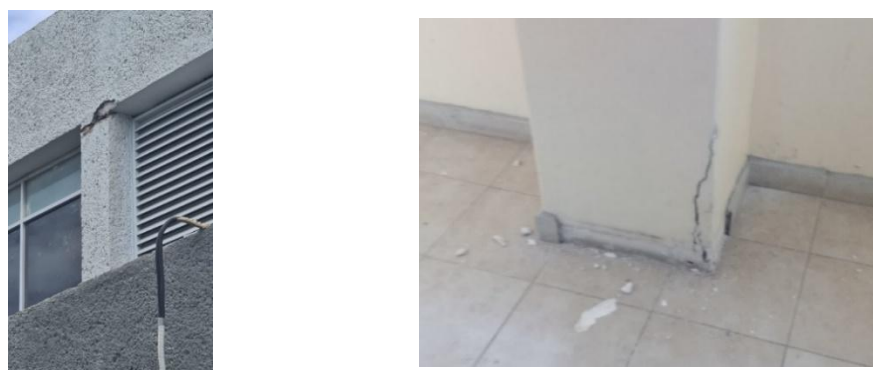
Falla de columna corta en la planta baja y agrietamiento vertical en una columna del primer nivel.
